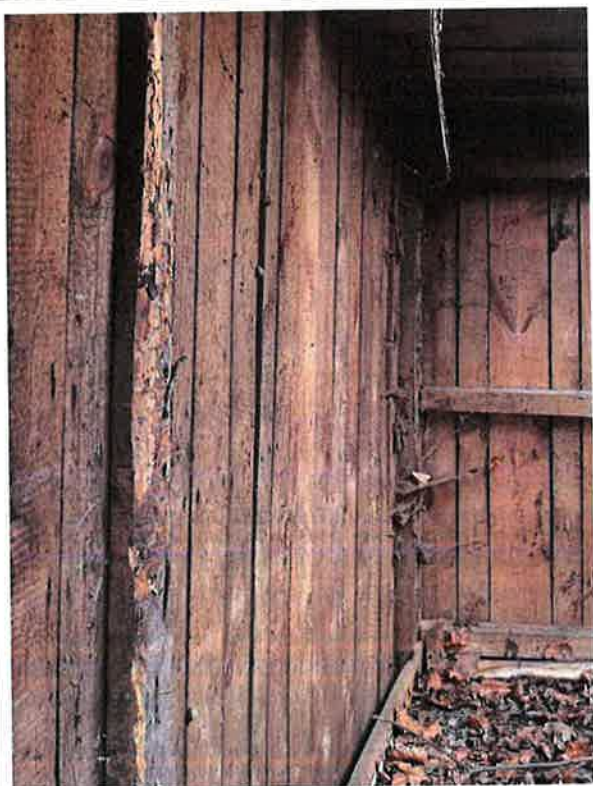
Zniszczenie konstrukcji i pokrycia dachu oraz wewnętrznego obicia ścian z drewna
